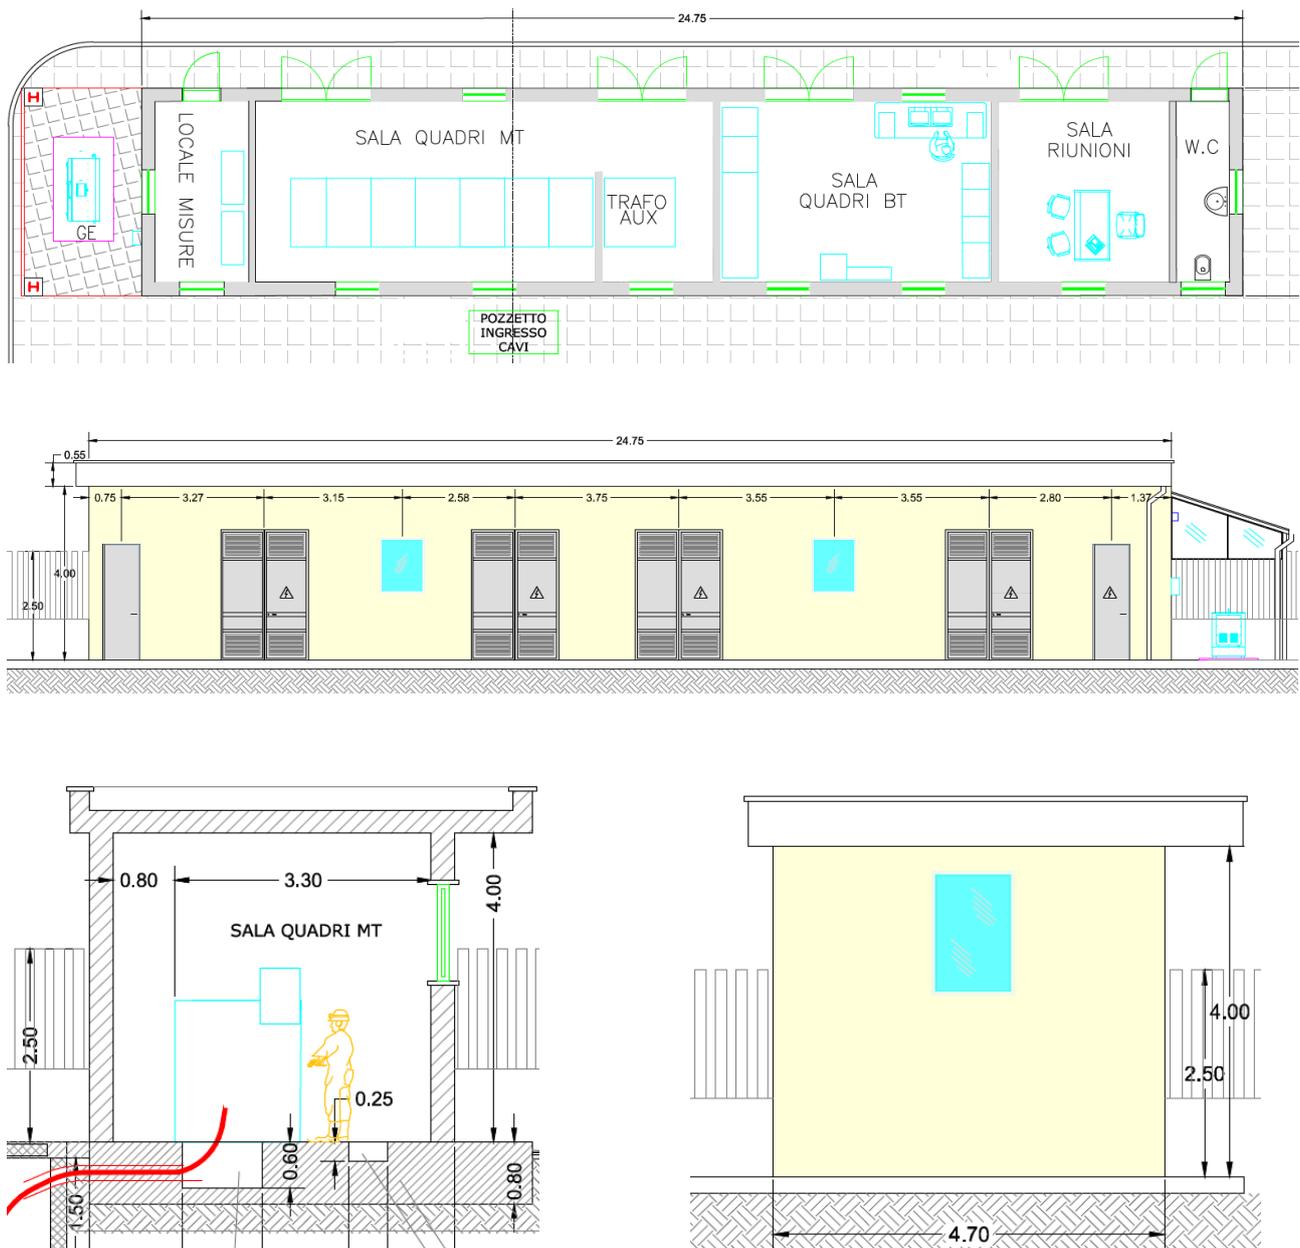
Pianta, prospetti e sezioni edificio utente
